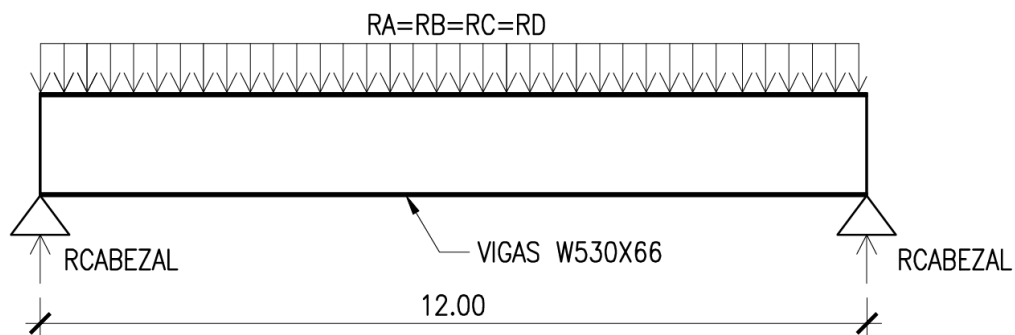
Esquema de cargas sobre las vigas metálicas.
